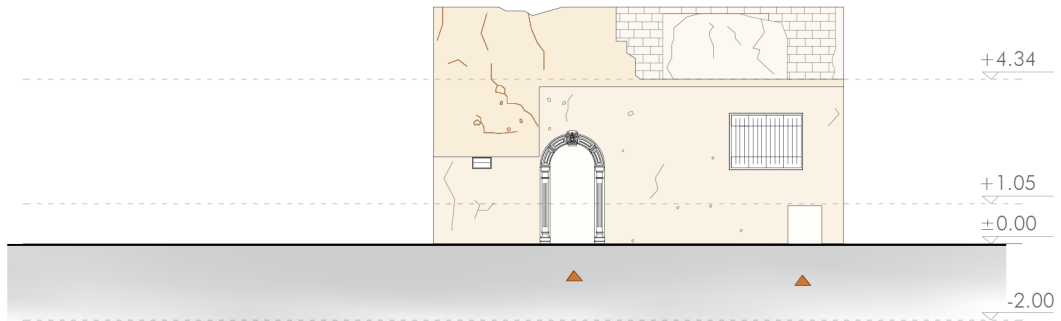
Prospetto nord della casa 9. Scala 1/200
